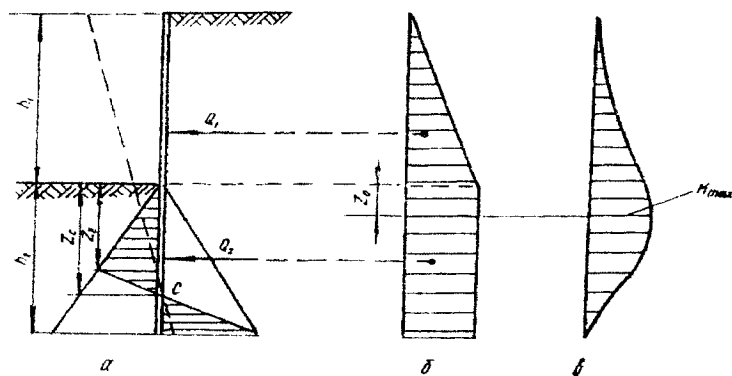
Розрахункова схема тонкої незаанкерованої підпірної стіни:
